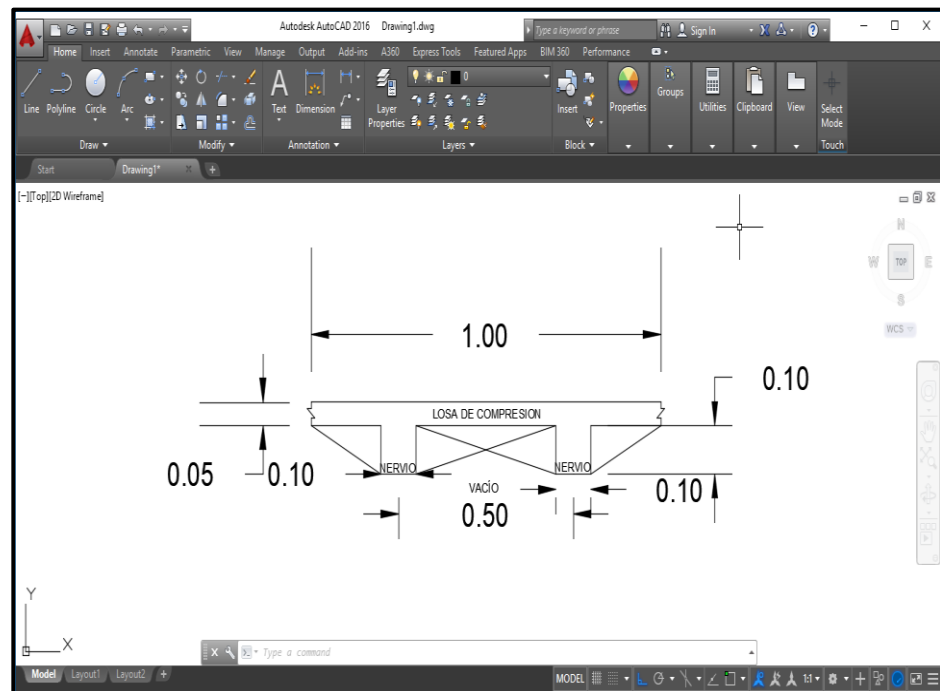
Sección transversal losa nervada en 2 direcciones
